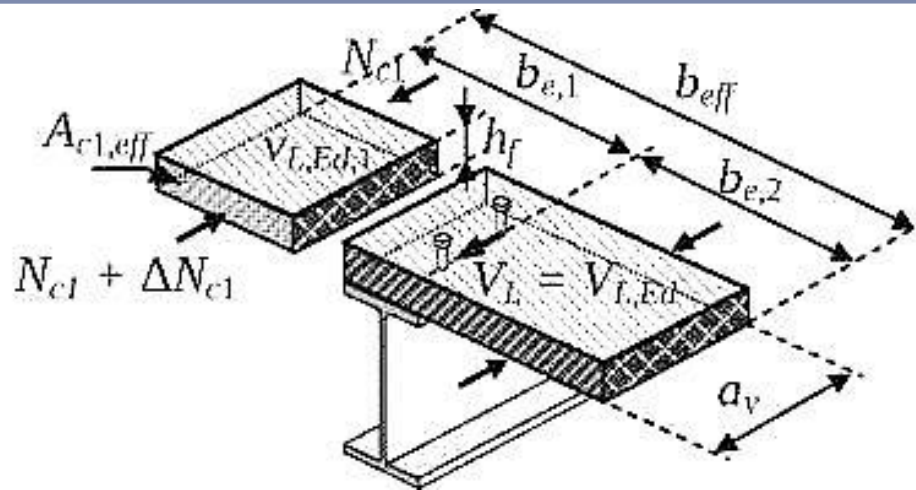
Расчет на горизонтальный срез бетонного пояса
